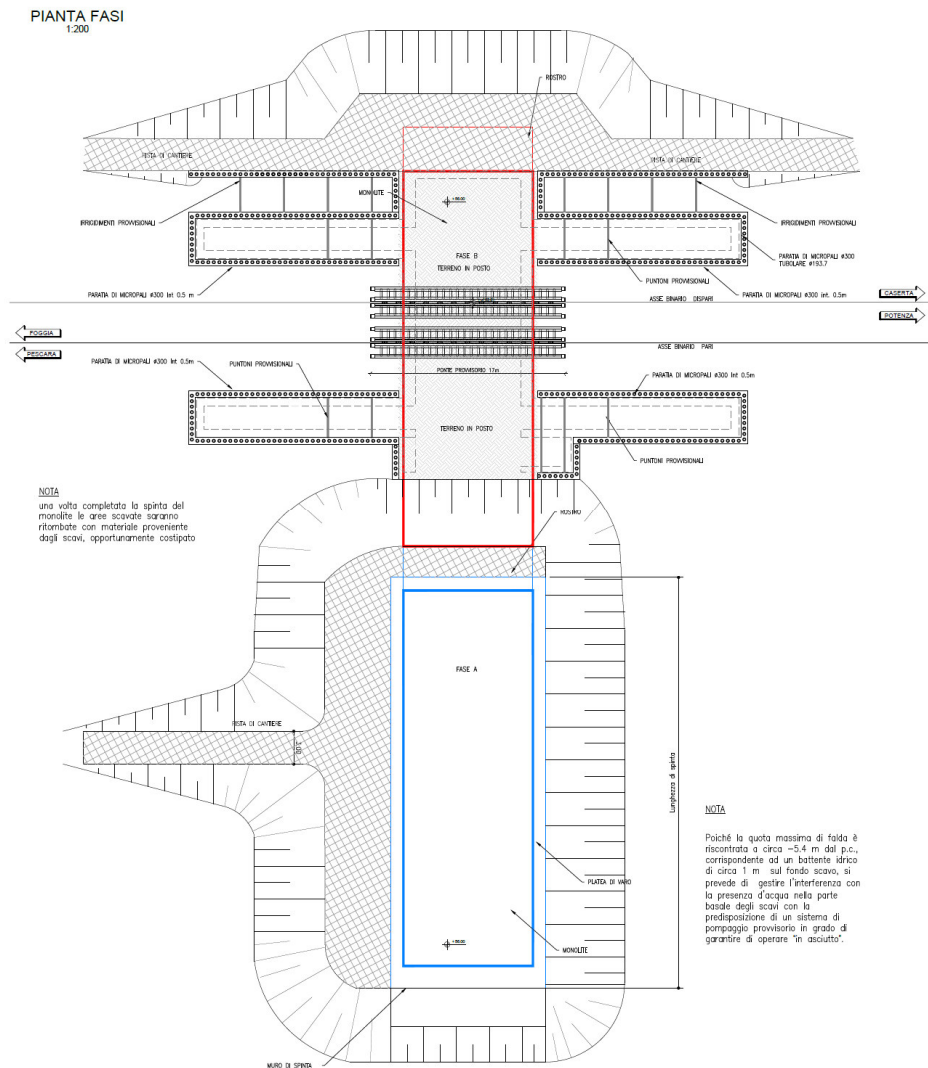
stralcio planimetrico Monolite a spinta e platea di varo
